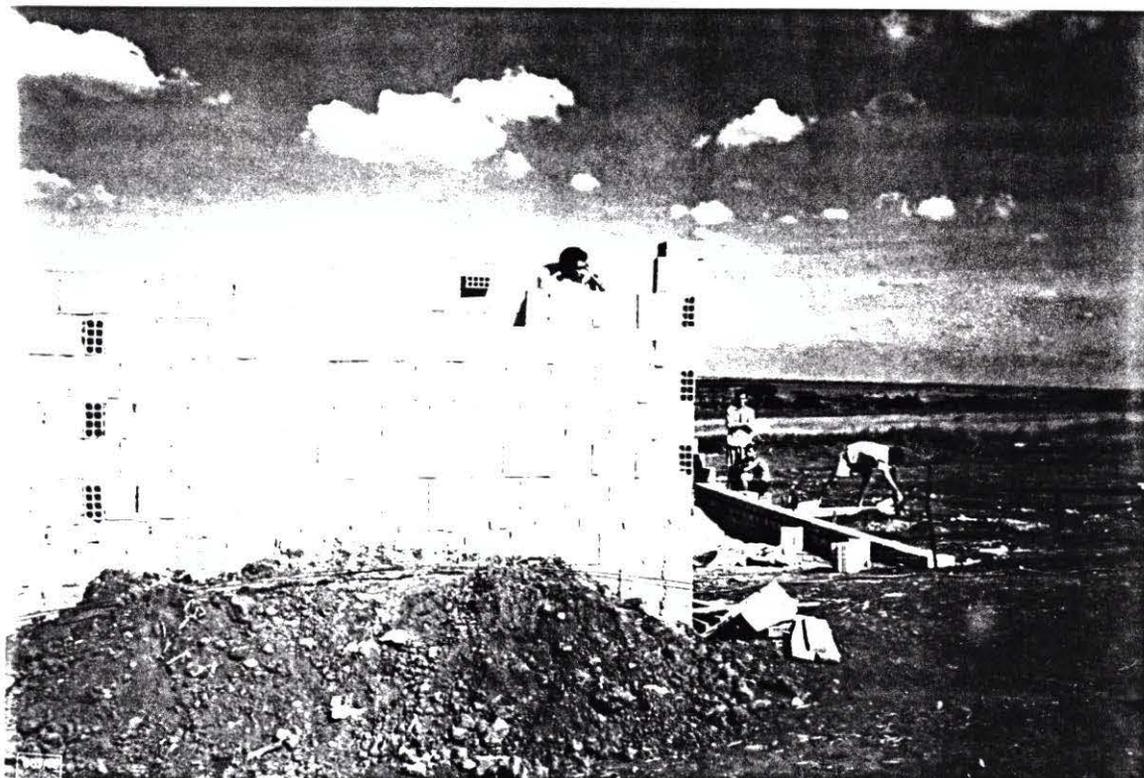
Construção em terrenos adquiridos através do FUMHAP - 1995 (autoconstrução)
